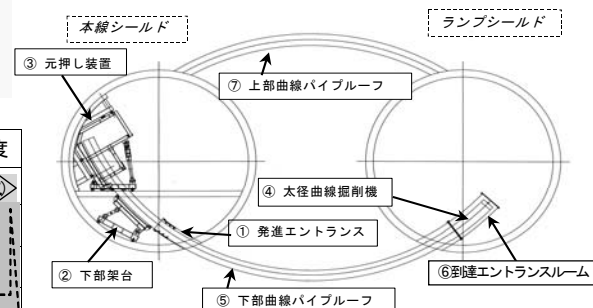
太径曲線パイプルーフ工法施工機器材と配置状況
